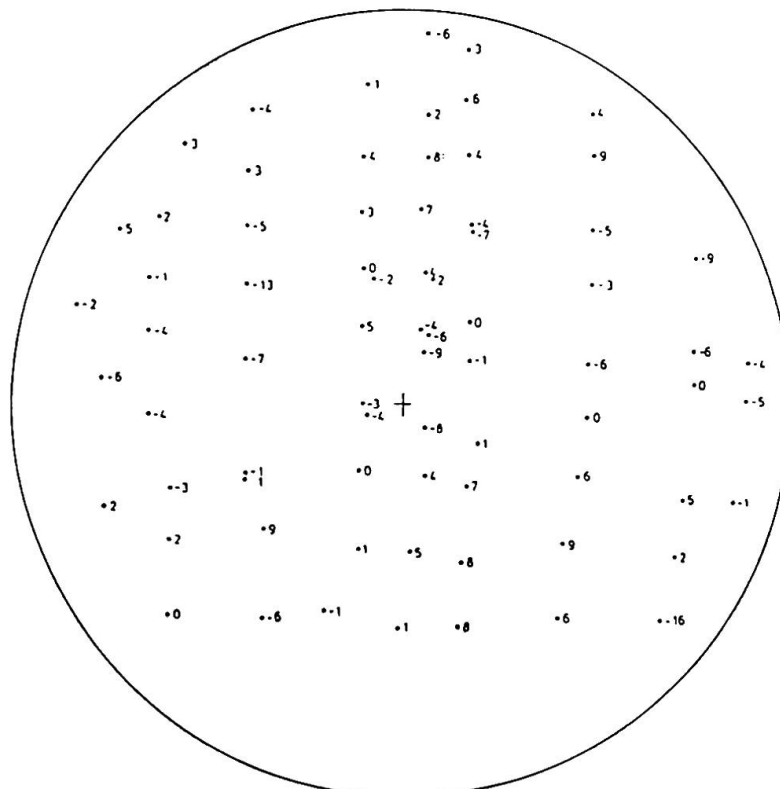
Radiusabweichungen einer Gaskugel in mm
